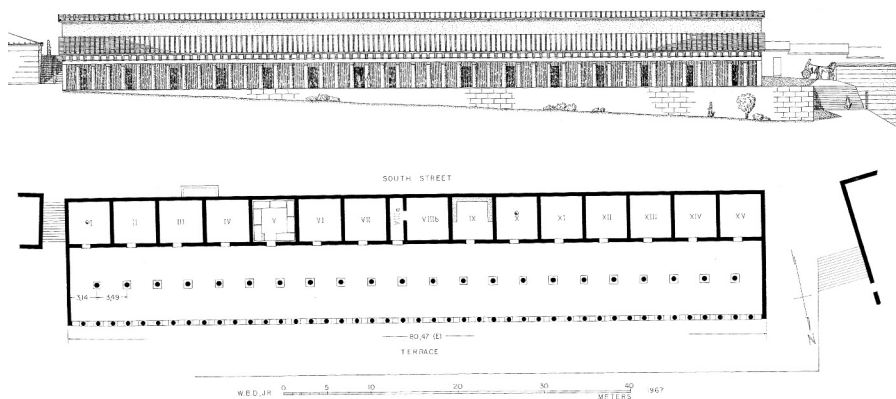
Ricostruzione della pianta (in base ai dati di scavo) e del prospetto settentrionale della Stoa Sud I (dis. W. B. Dinsmoor Jr., THOMPSON 1968)
